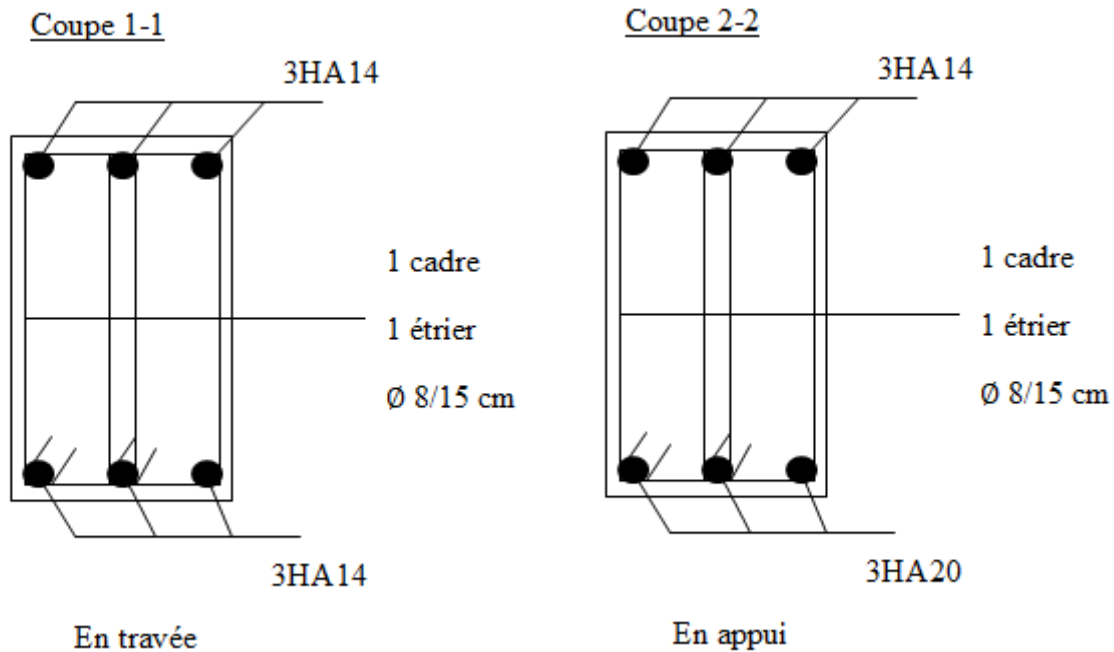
schéma de ferrailage transversal des poutres secondaires.
